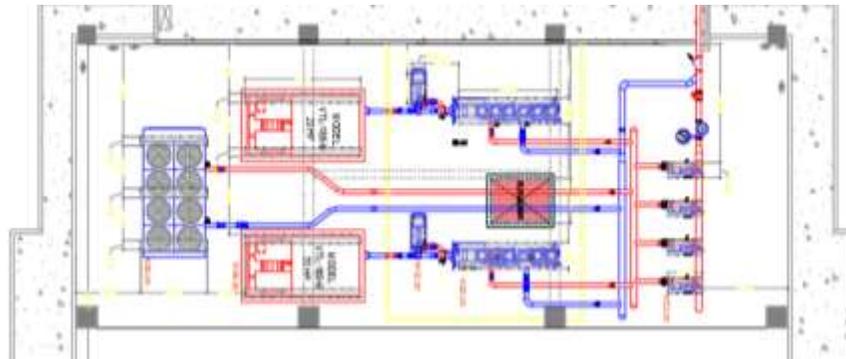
Planta Arquitectónica Azotea Torre 3
